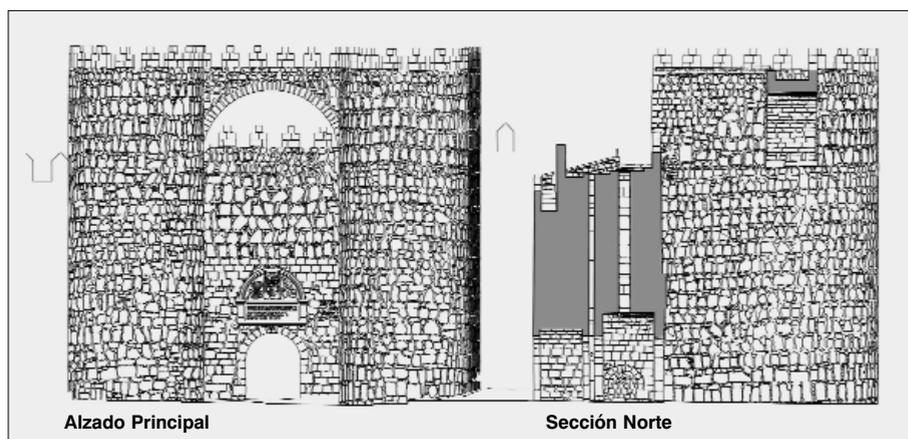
Puerta del Alcázar, del proyecto de restauración de José Ramón Duralde.
